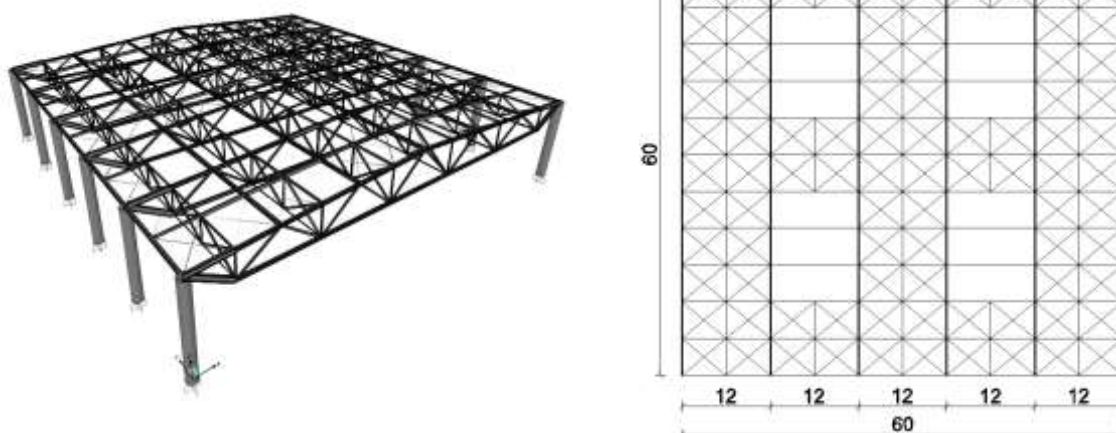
Structura cu deschidere de 60m (Str60m)
